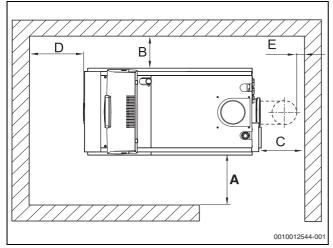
Distances par rapport aux murs dans le local d'installation (modèle droit)
